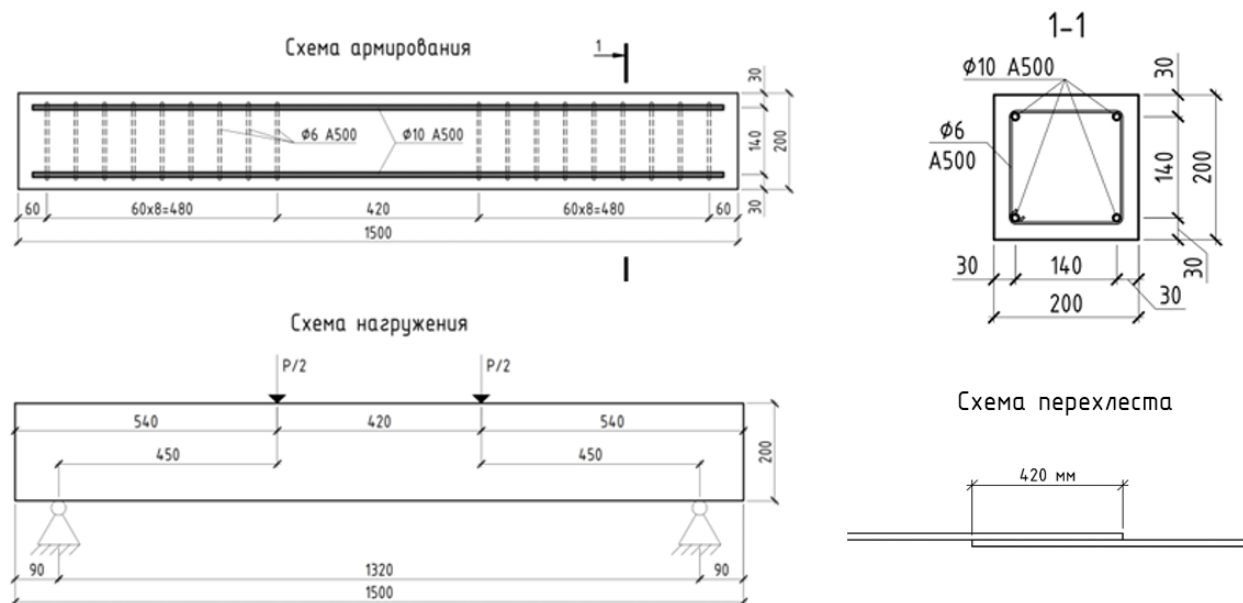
Размеры, схема армирования и нагружения исследуемых железобетонных балок
